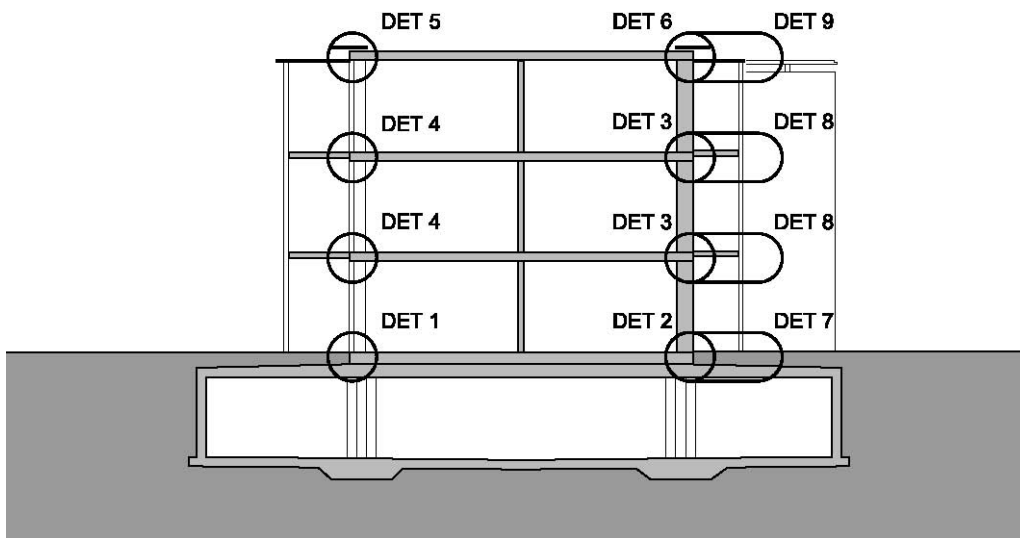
Schnitt, Projekt "Ölzbündt" M 1:200
